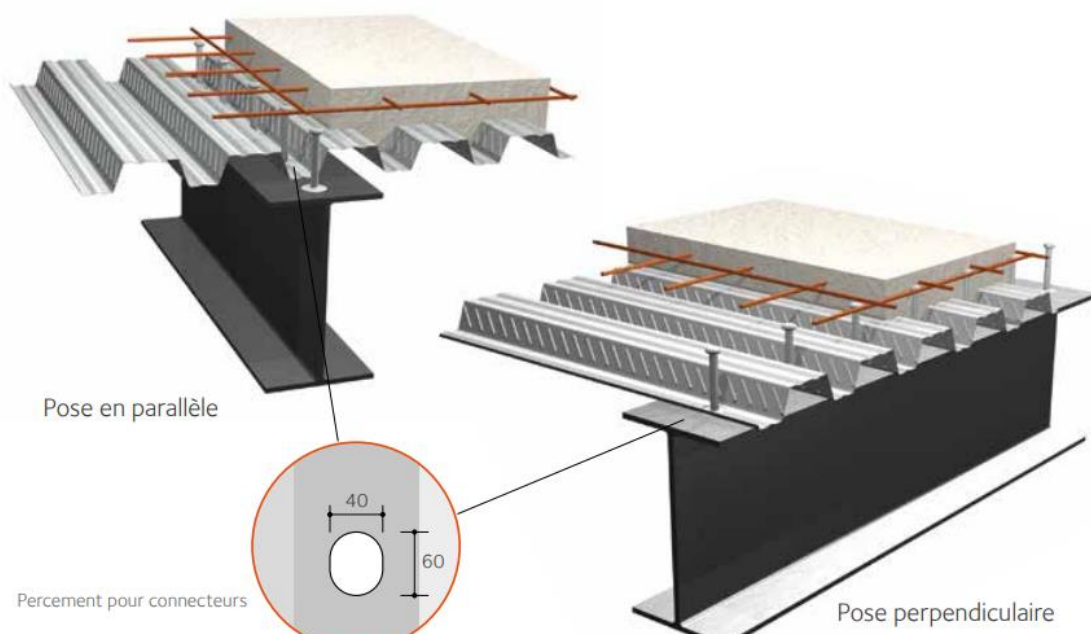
Vue sur plancher collaborant sur Poutre en treillis Source : <https://construction.arcelormittal.com>
